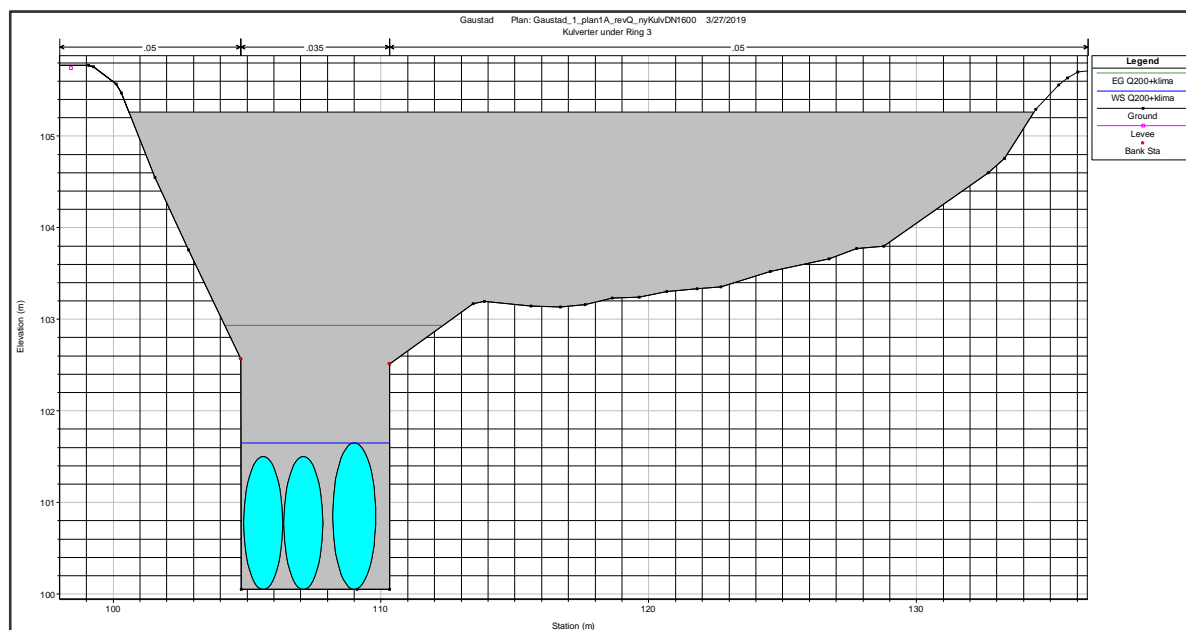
Nytt kulvertløp Ø1600 mm (til høyre) lagt til de to eksisterende Ø1450 mm-kulvertene (til venstre) under Ring 3.
